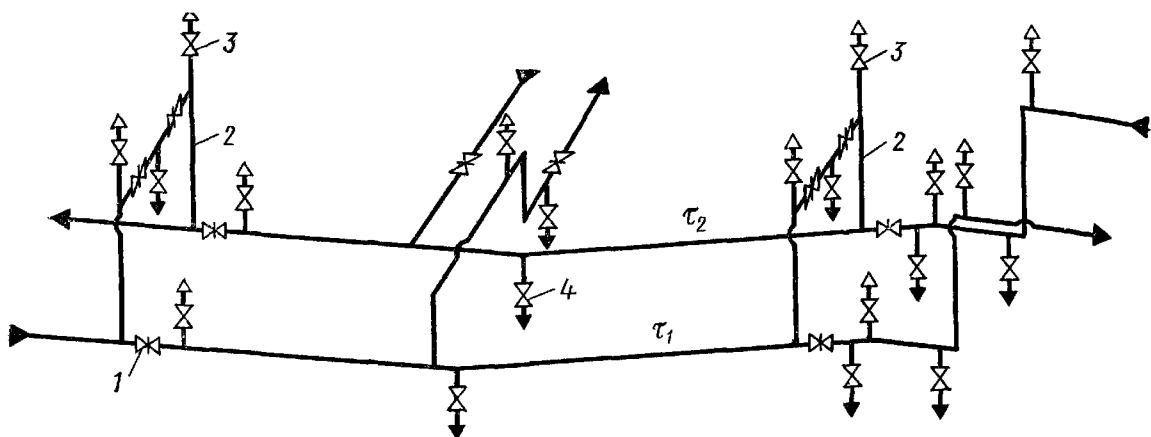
Схема размещения арматуры на водяных тепловых сетях:
